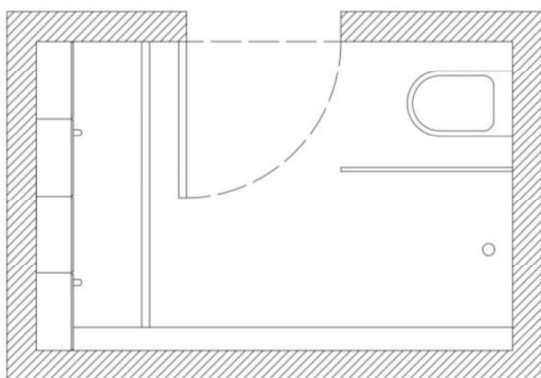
Planta de proposta II da instalação sanitária social. Fonte: Autor
